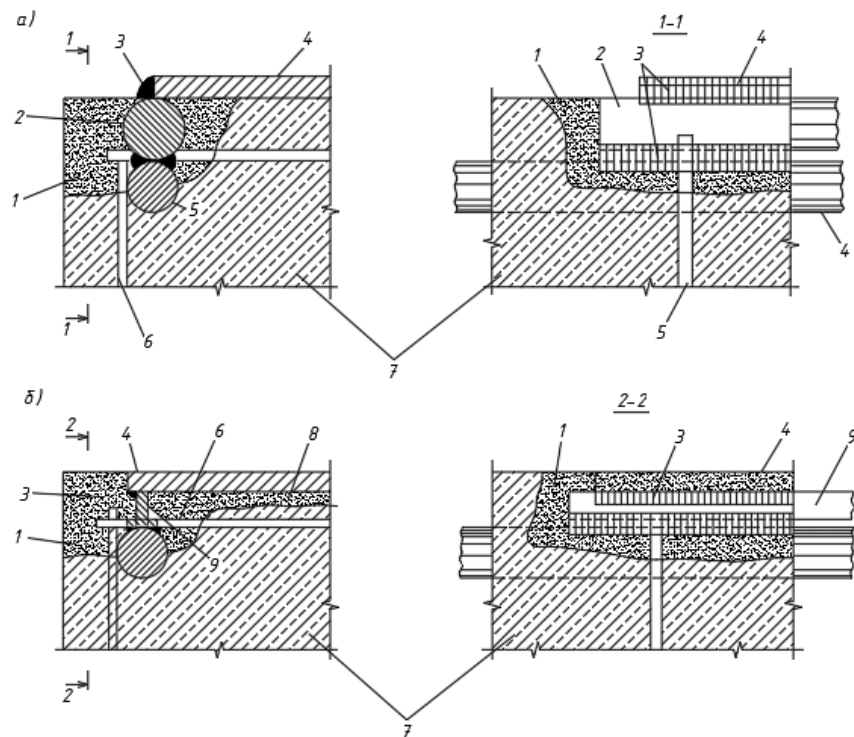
Установка дополнительных закладных деталей в железобетонных элементах: а - по верхней плоскости; б – у уровень с поверхнею: 1 - сколота зона бетона, в результате забита цементным раствором; 2 - коротун-подкладка з круглого стержня; 3 - сварні шви; 4 - додаткова закладна деталь; 5 - кутова арматура елемента; 6 - поперечні стрижні каркаса; 7 - виправний елемент; 8 - поперечна борозна для установки заставної деталі, заповнена в результаті цементним розчином; 9 - коротун-прокладка зі смугової сталі
